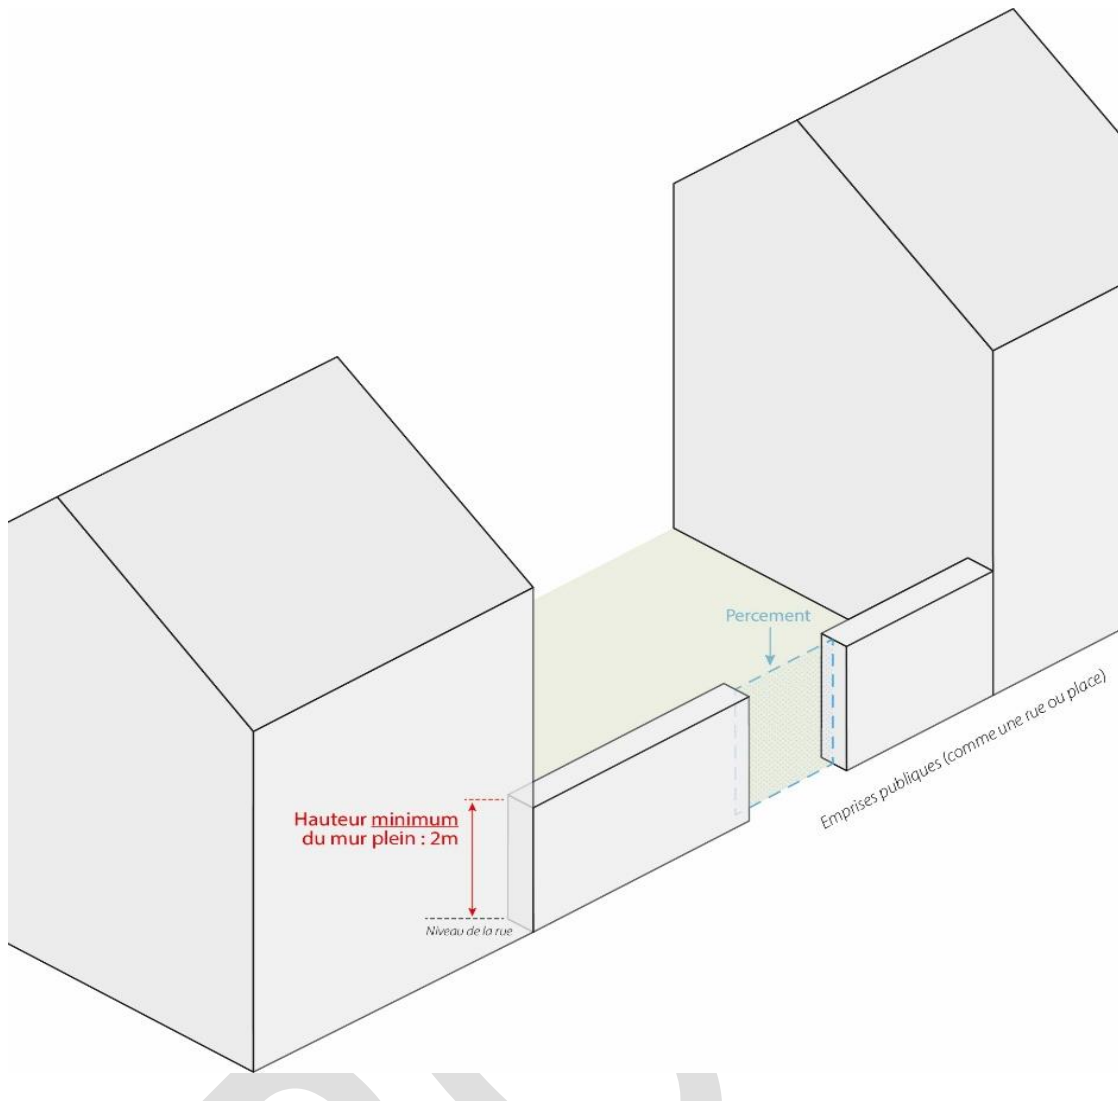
Schéma d'une clôture sous forme de mur plein en limite d'une emprise publique lors d'une continuité urbaine existante (illustration sans valeur réglementaire)
